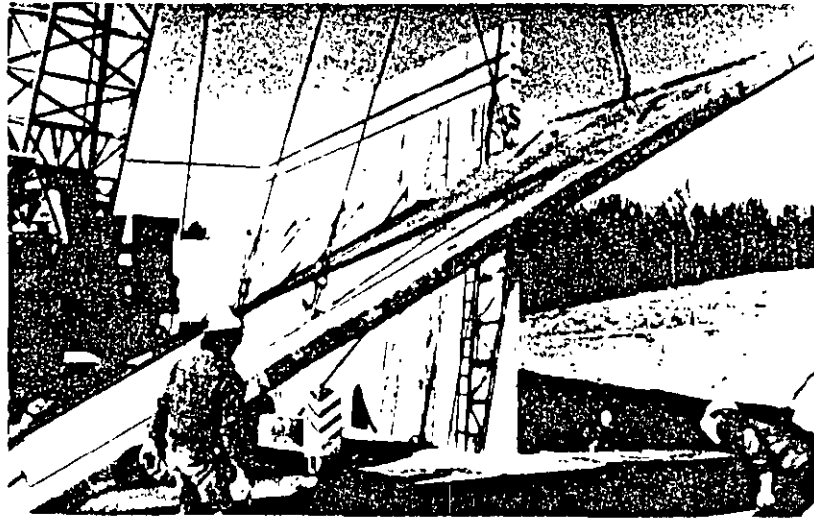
Montaje por volteo de un panel con arriostramiento de tubo ya fijado. El arriostramiento estabiliza el panel del muro hasta que toda la estructura quede convenientemente amarrada.
